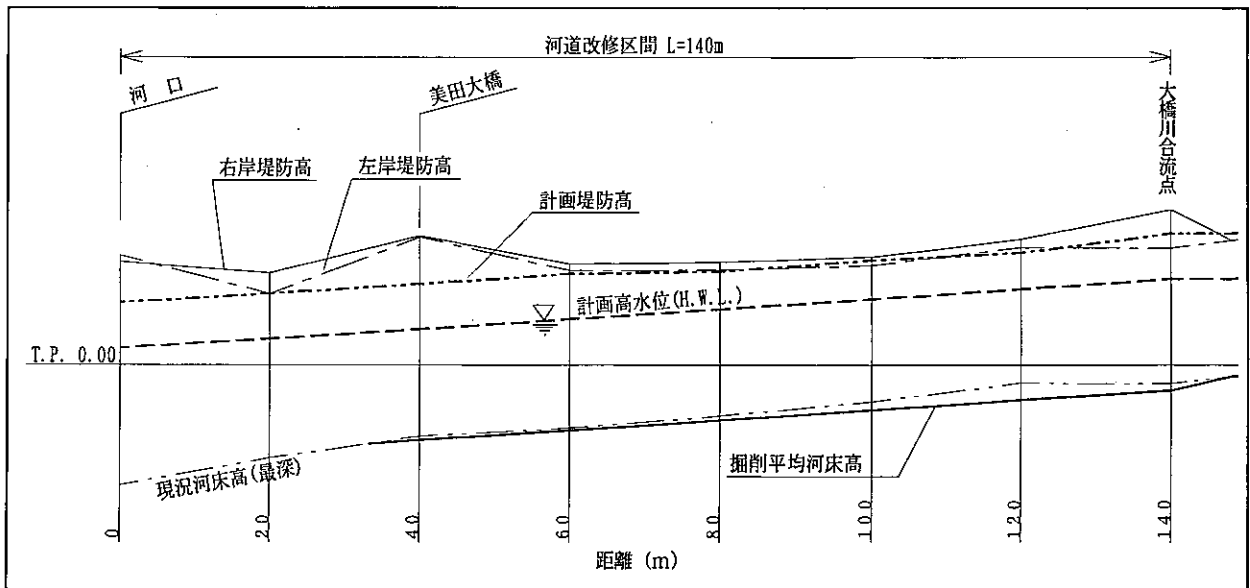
(8) 縦断面図 (V=1:100, H=1:1,000)
